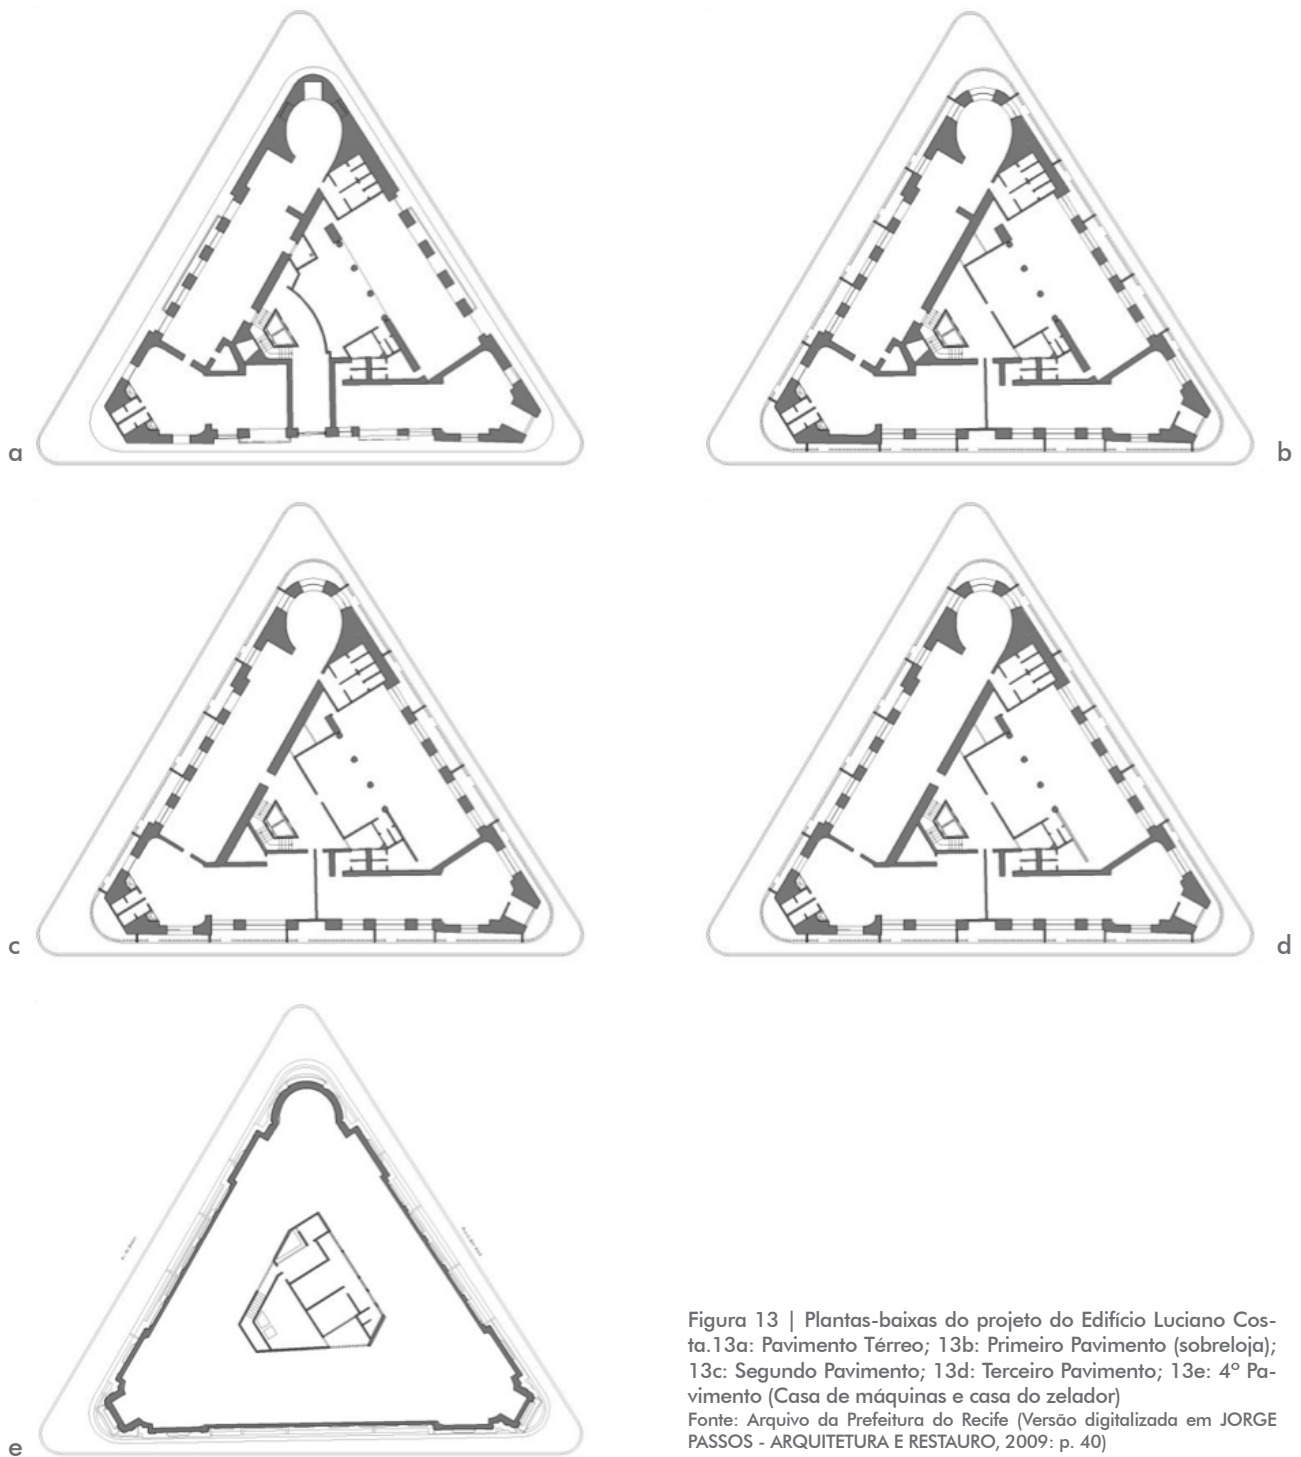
| Plantas-baixas do projeto do Edifício Luciano Costa. 13a: Pavimento Térreo; 13b: Primeiro Pavimento (sobrelója); 13c: Segundo Pavimento; 13d: Terceiro Pavimento; 13e: 4º Pavimento (Casa de máquinas e casa do zelador)
